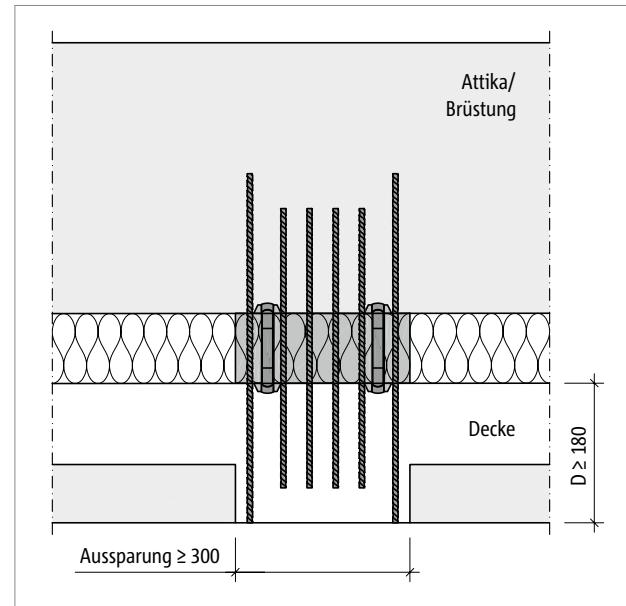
Schöck Isokorb® CXT Typ AP: Ansicht; Mindestabmessung Aussparung Elementplatte
